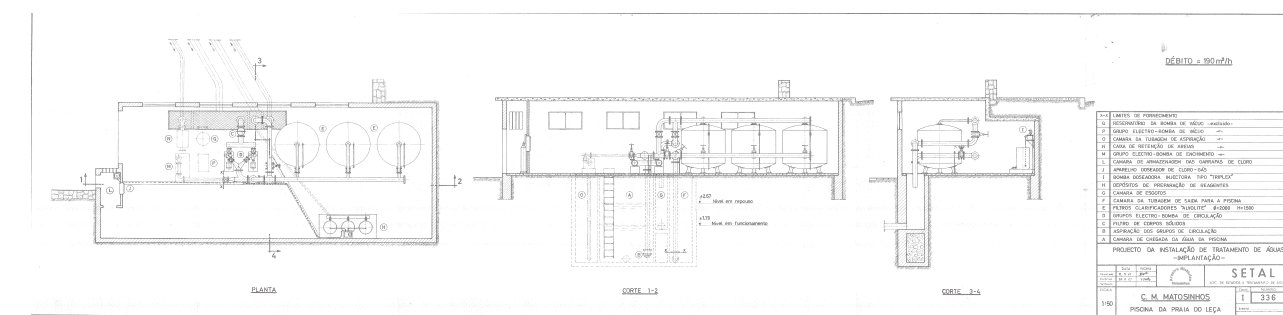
Planta e cortes da estação de tratamento de águas da Piscina de Leça da Palmeira (1961) - Álvaro Siza Vieira
